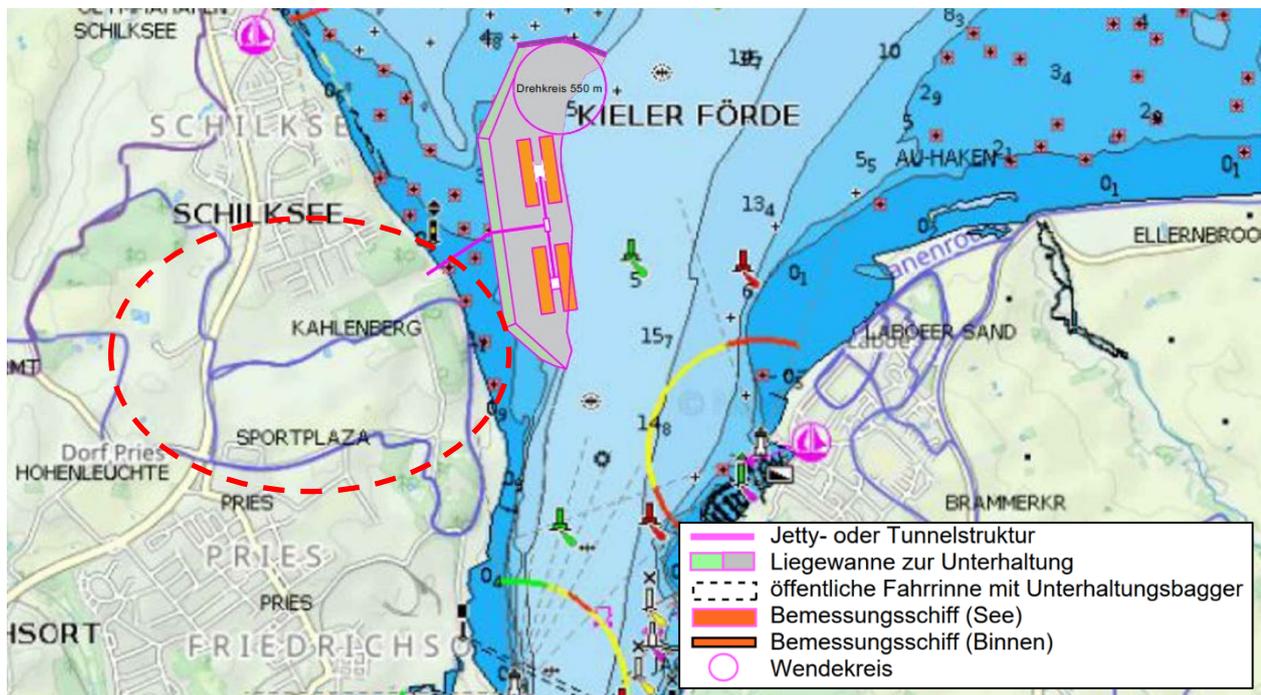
Lageplan Alternative 11: Kiel¹⁹³
